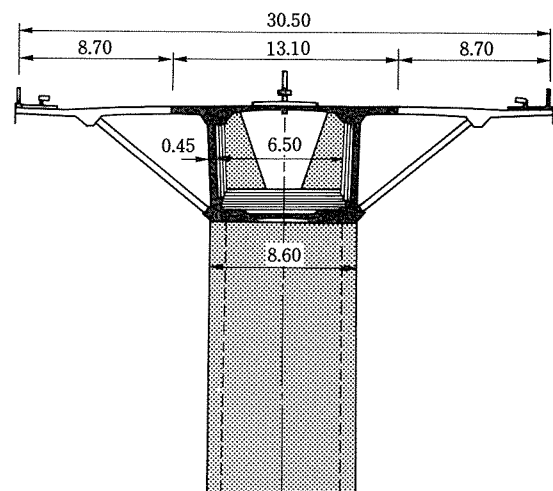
主桁断面図 (箱桁はキャンチレバー施工され、張出し床版は後打ち施工される)
